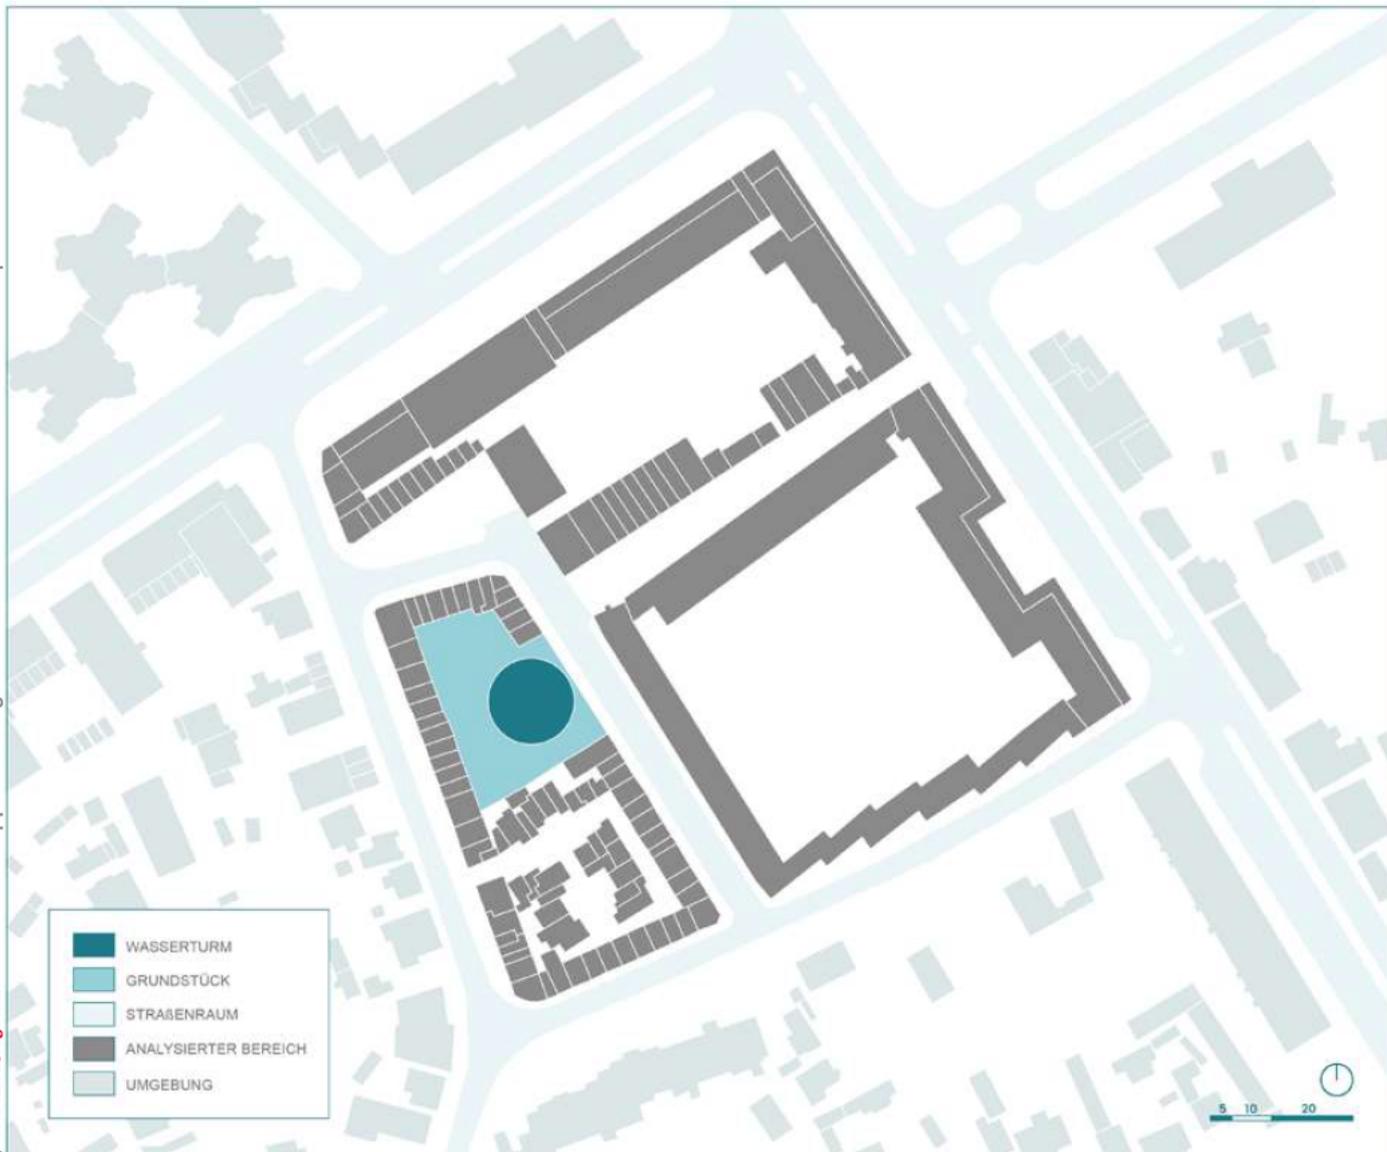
Lageplan Bestand - Situationsanalyse
